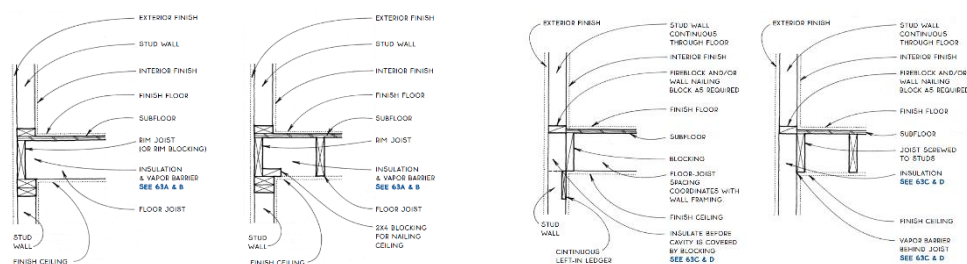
Encontro do pavimento com a parede exterior nos sistemas "platform frame" e "balloon frame" (Thalon, 2009).
